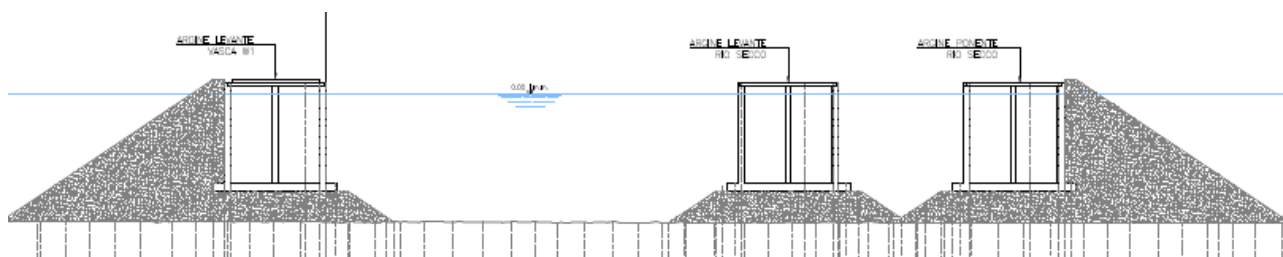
Sezione trasversale di progetto della Vasca W1 Bacino Sud e Rio Secco
